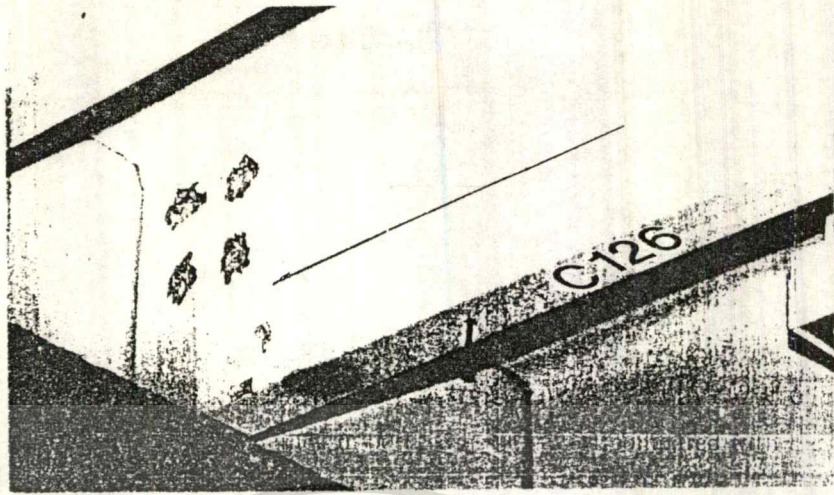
(a)เหล็กเสริม dowel bar ที่ออกแบบเพื่อเชื่อมแผ่นพื้นกับคาน
